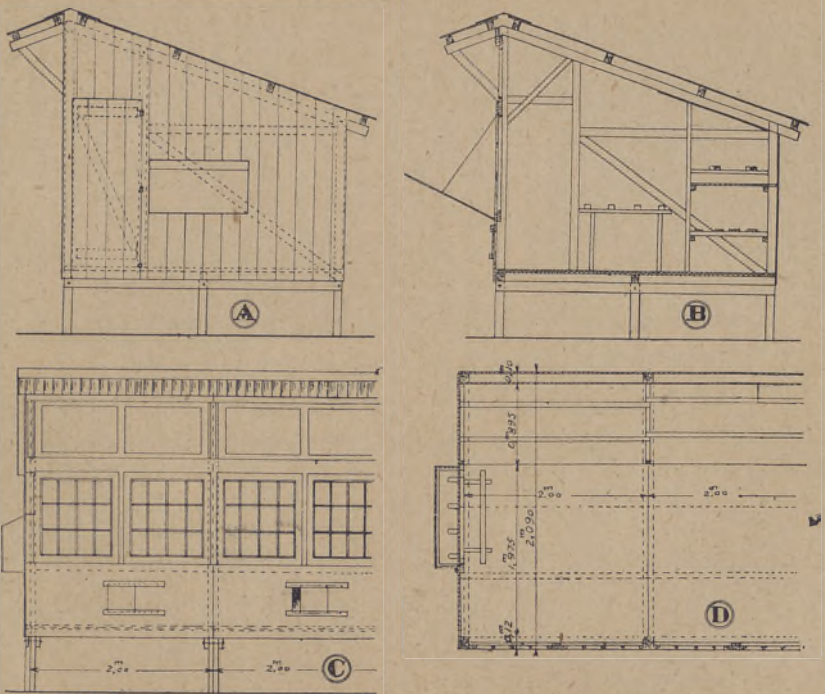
Galinheiro extensível, modelo C. Lacombe. A, fachada lateral B, Corte transversal mostrando o aspecto por dentro. C, fachada principal. D, planta, corpos iguais de 2 em 2 metros
